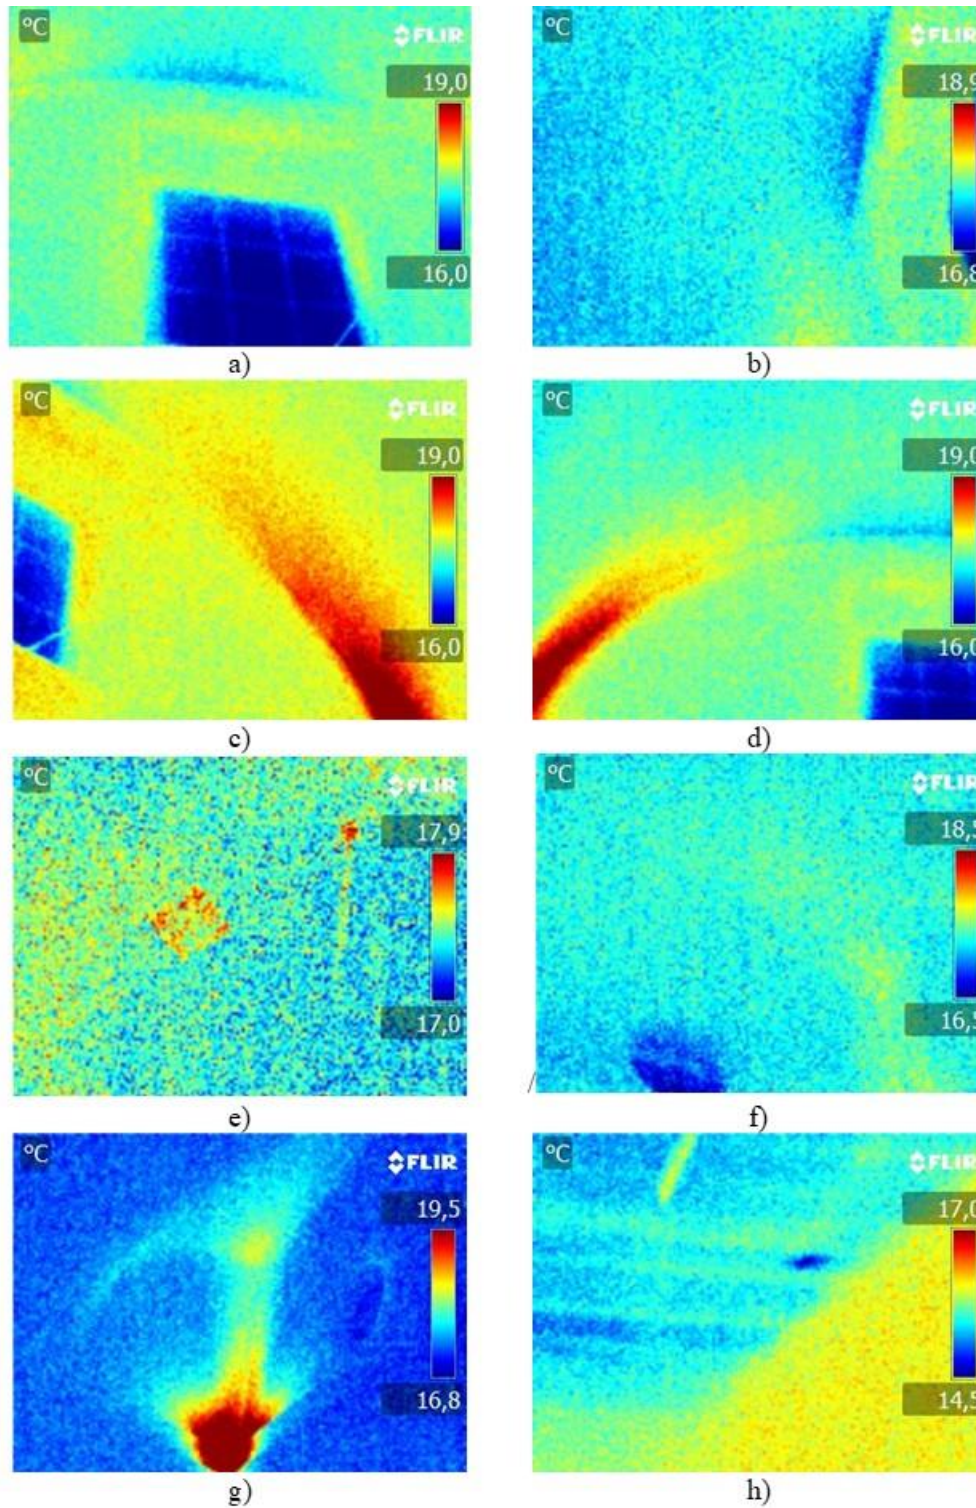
Termografía sala bajo cubierta 2: a) zona de ventana y forjado, b) Vista inferior de la cubierta, c) Vista conexión paramento lateral forjado, d) Vista conexión paramento lateral forjado, e) zona central de cubierta, f) Vista de muro divisorio trasero, g) Vista conexión paramento lateral y muro trasero, h) Gotera en zona de edificio anexo.
